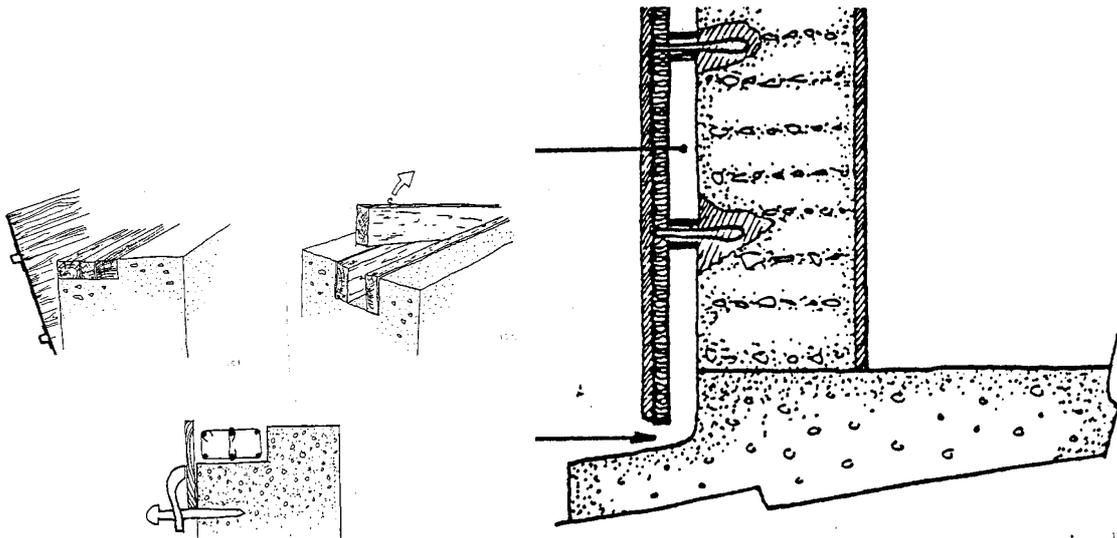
detalle ejecución zuncho embebido en tapial y a la derecha detalle tabique pluvial ventilado.
